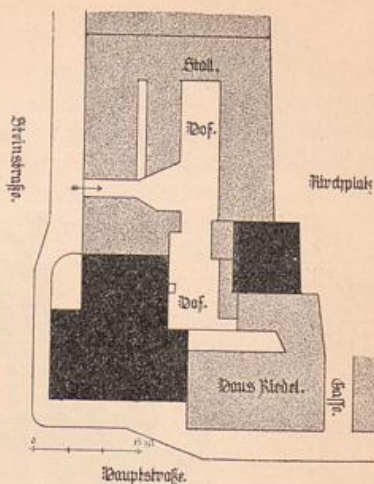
Lageplan des ehemals Storbek'schen Hauses.
